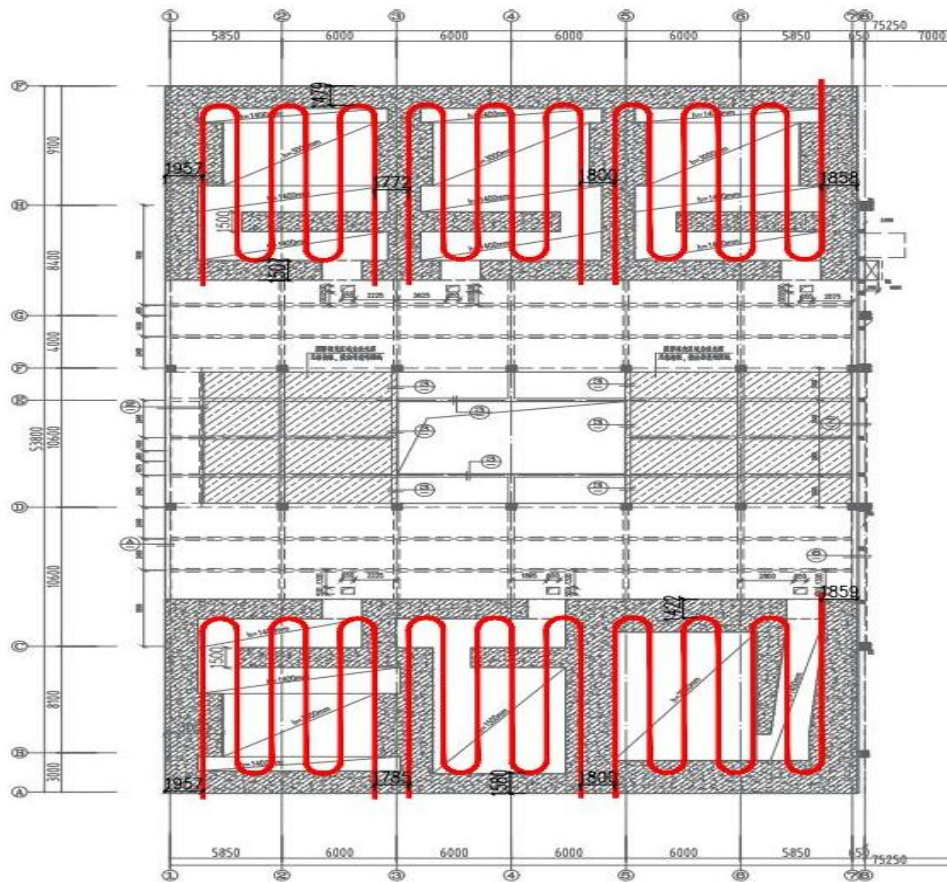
直线加速器机房顶板混凝土水冷却管平面布置图
